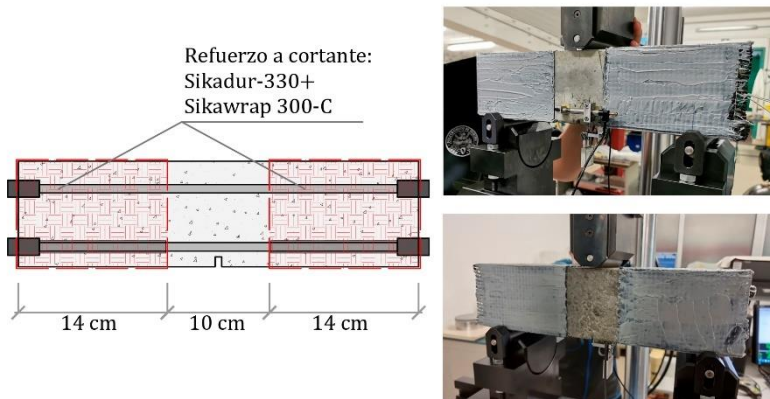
46- Refuerzo de las vigas. Elaboración propia.
